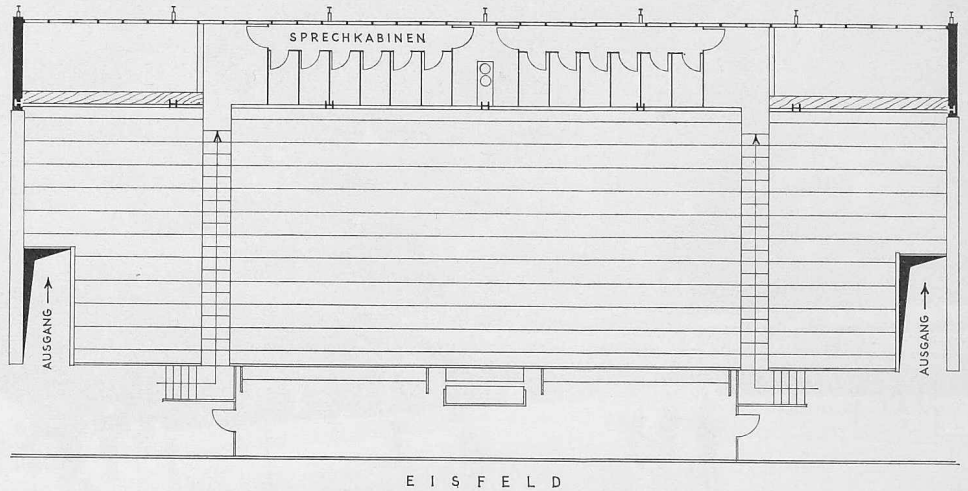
Tribünengebäude, Grundriss 1:300 des 2. Obergeschosses
